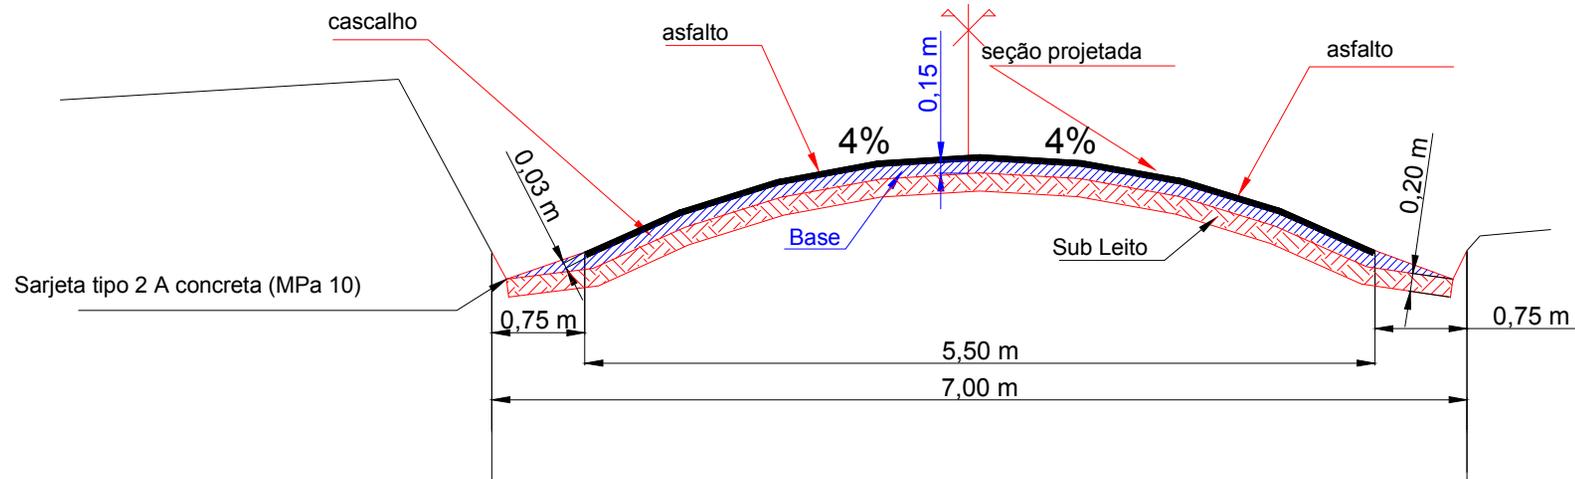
FOTO REVESTIMENTO ALTERNATIVO TIPO B1
